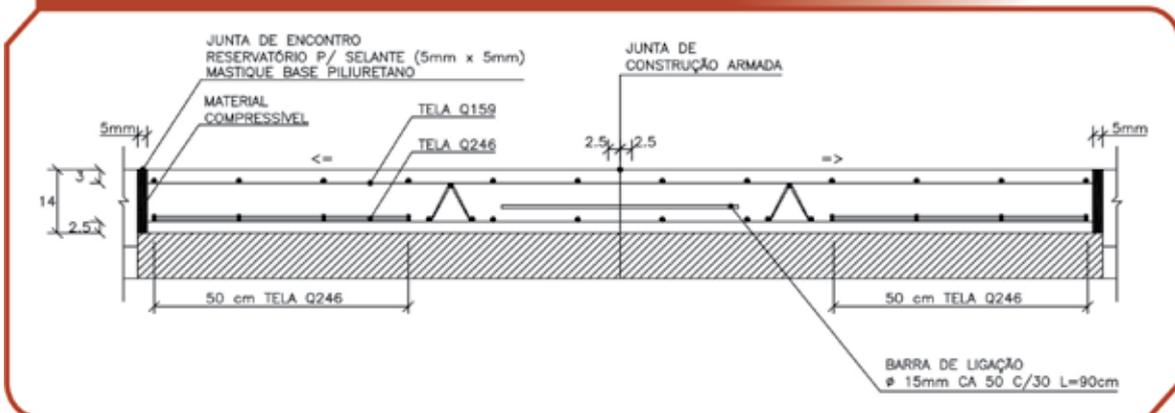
Seção-tipo do pavimento de concreto – estações de parada – pavimento estruturalmente armado
